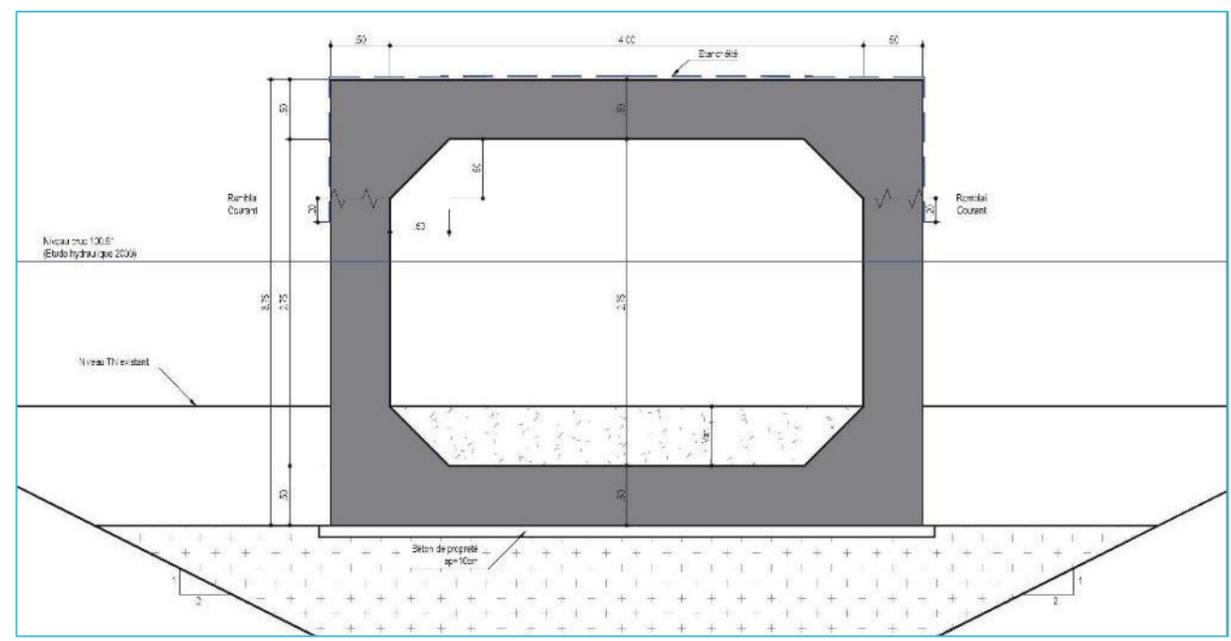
Coupe transversale des ouvrages de décharge (source : Setec 2023)
